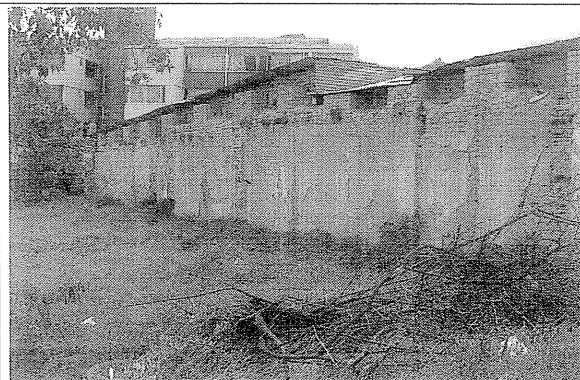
Pérdida de verticalidad en el extremo norte del muro de lindero.
